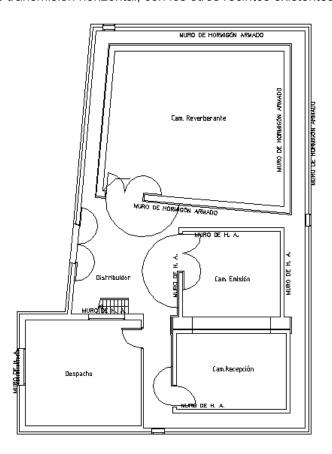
Planta del edificio que contiene las cámaras acústicas en el campus de Cáceres de la Universidad de Extremadura.
